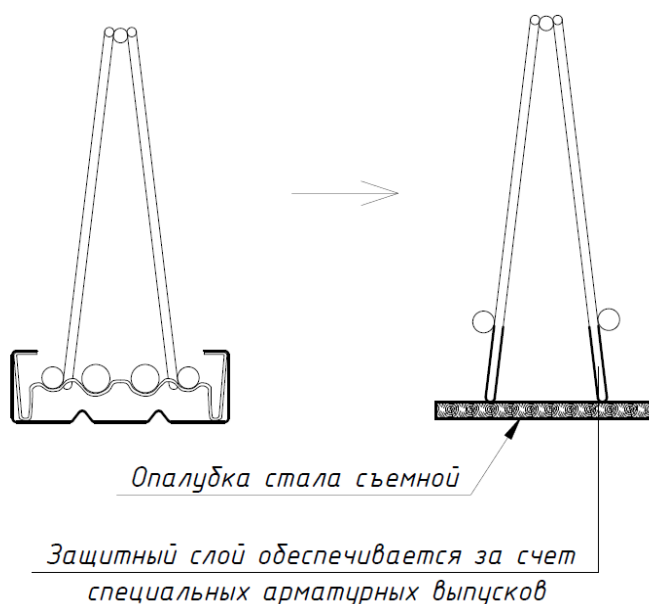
Совершенствование конструкции армо-опалубочного элемента сборно-монолитного перекрытия
